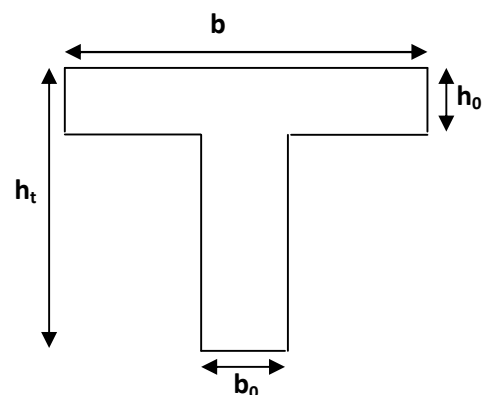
Schéma d'une section en T d'une poutrelle.
